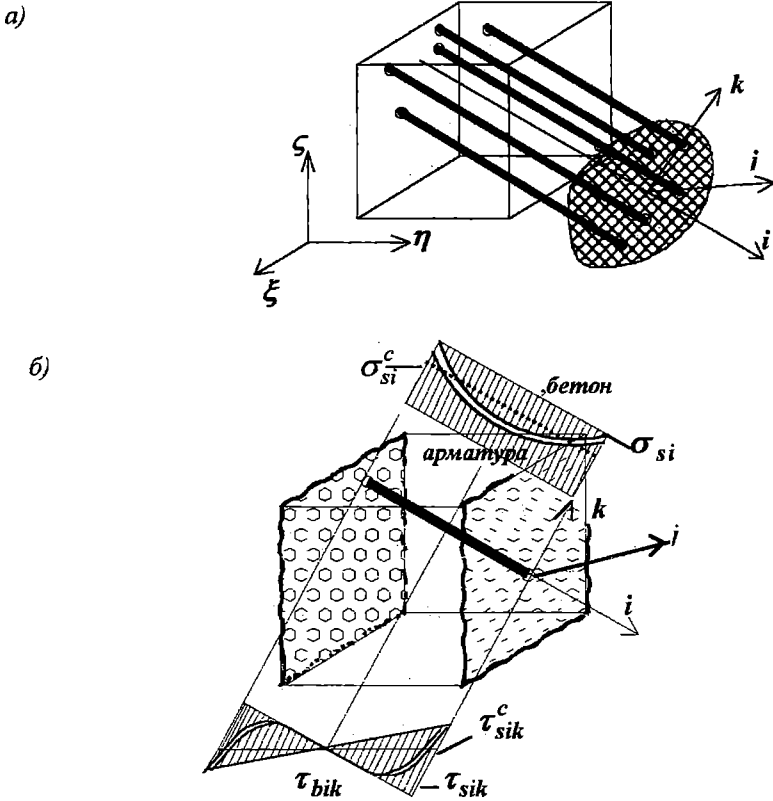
Железобетонный элемент без трещин и с трещинами
